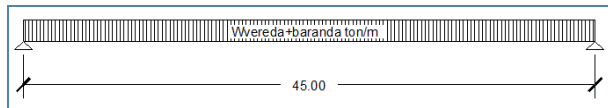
Etapa 3. Viga compuesta a cargas de largo plazo de veredas y barandas
